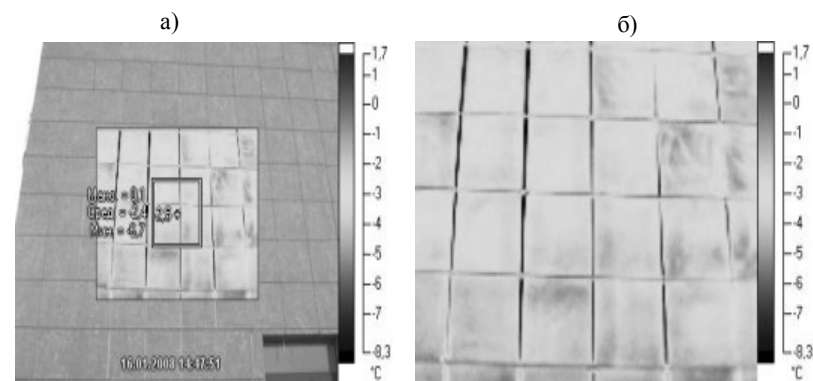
Административное здание каркасного типа с вентилируемым фасадом:
